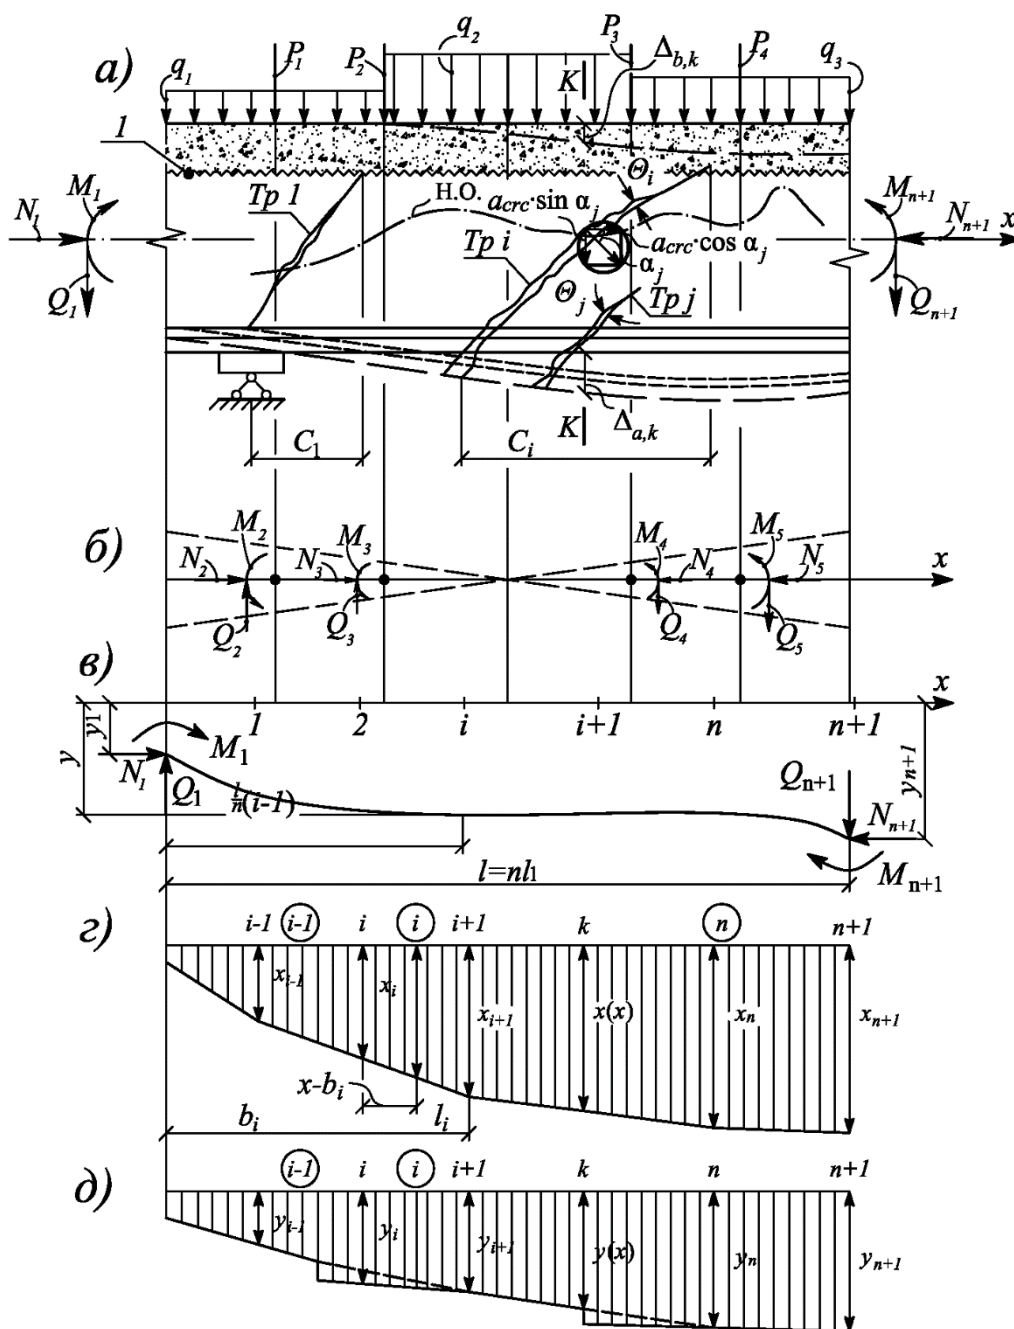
К расчету железобетонных составных конструкций по деформациям при наличии наклонных трещин: *a* — схема нагружения, трещин и перемещений в сечении *k*; *b* — схема приведения внутренних усилий M, N, Q к геометрической оси; *c* — изогнутая ось стержня; *d* — эпюра кривизн; *d* — эпюра прогибов; 1 — шов между бетонами
